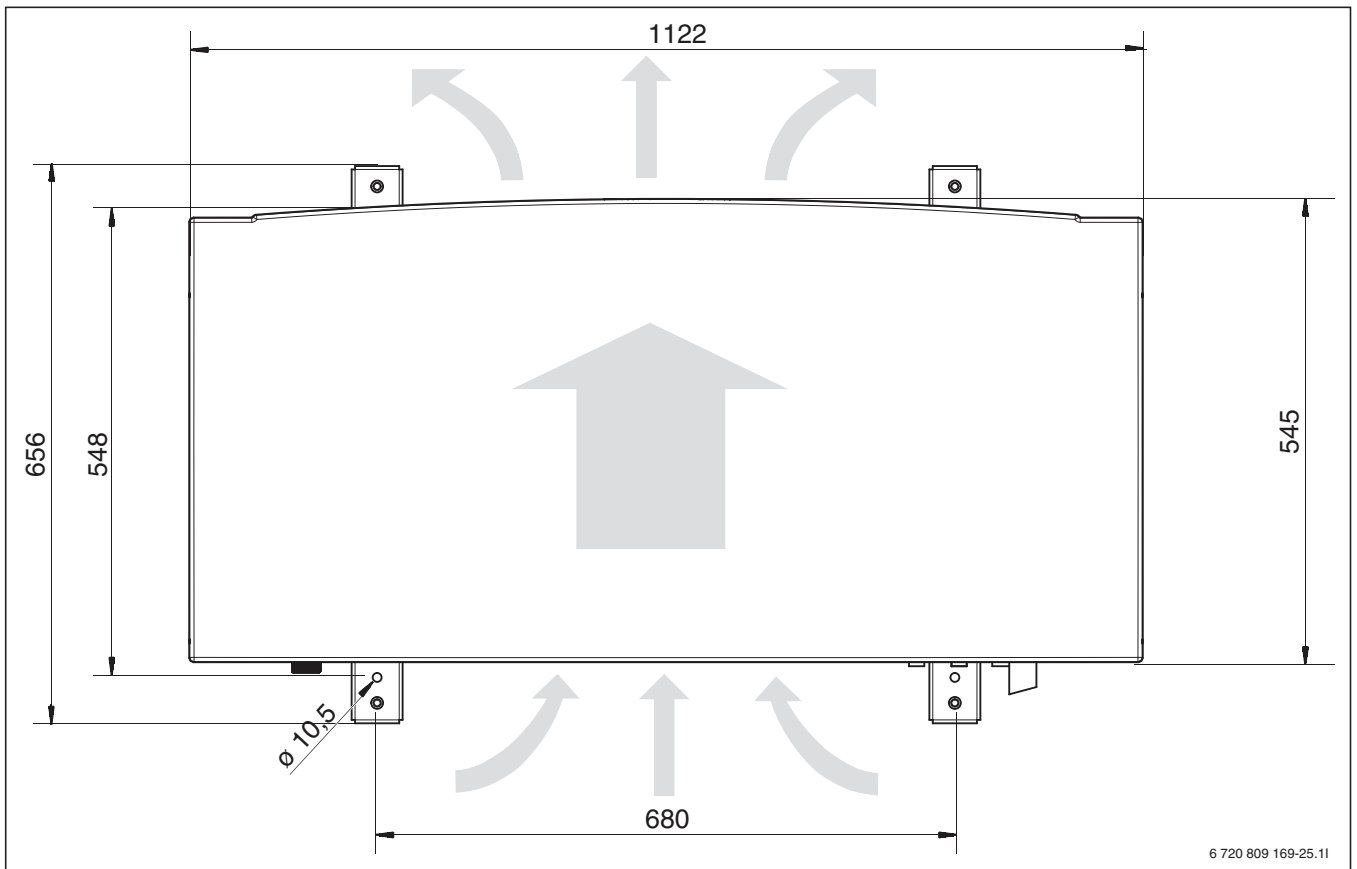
Abmessungen der Außeneinheit ODU11 und ODU14, Draufsicht
